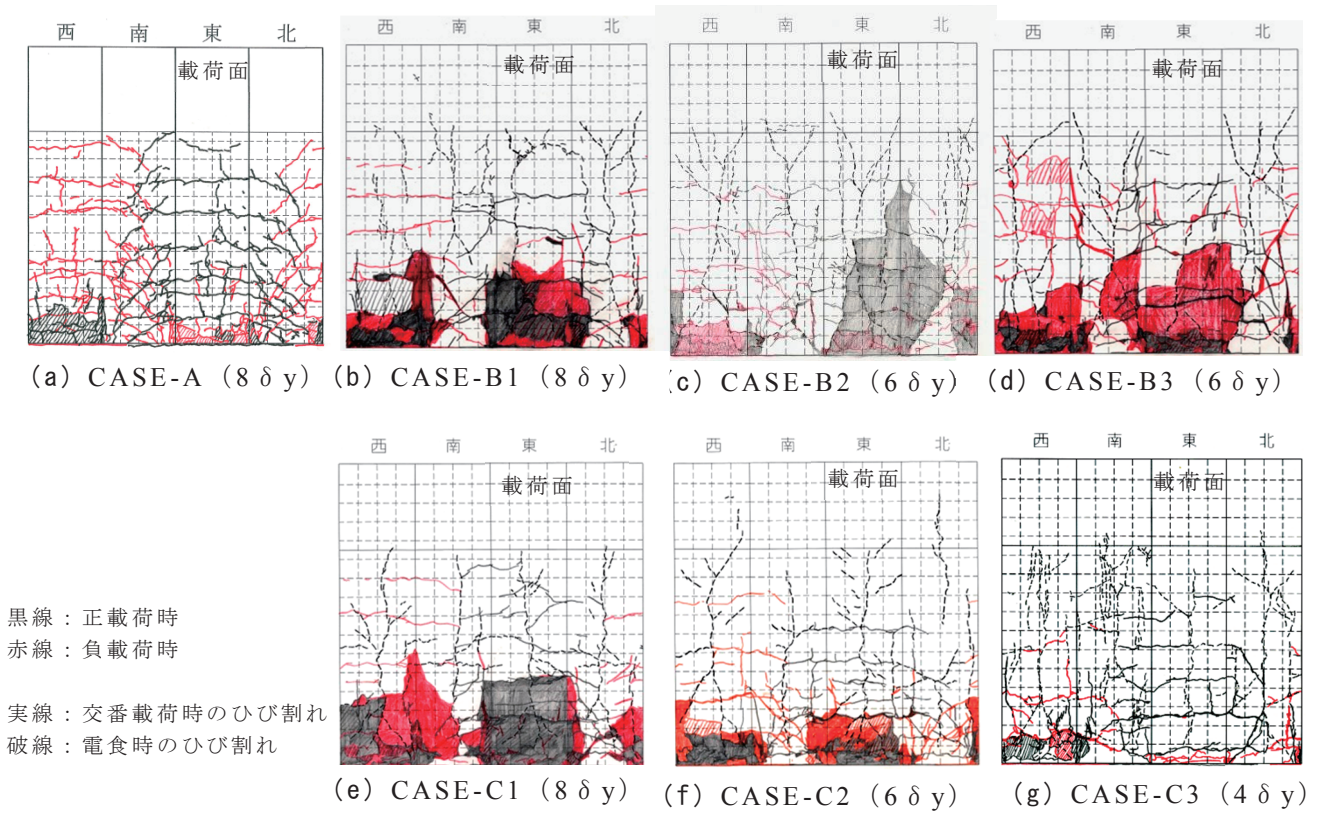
交番載荷実験・終局付近のひび割れ状況
